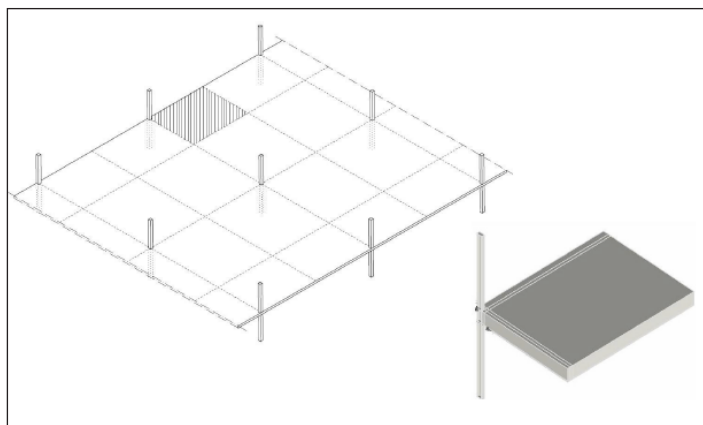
Plan och sektion genom en typisk anslutning mellan kantpelare i stål och betongbjälklag med plattbärlag.
